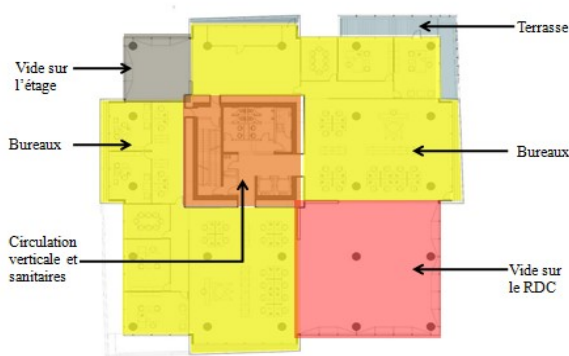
Plan du 3^{ème} et 4^{ème} étage.
